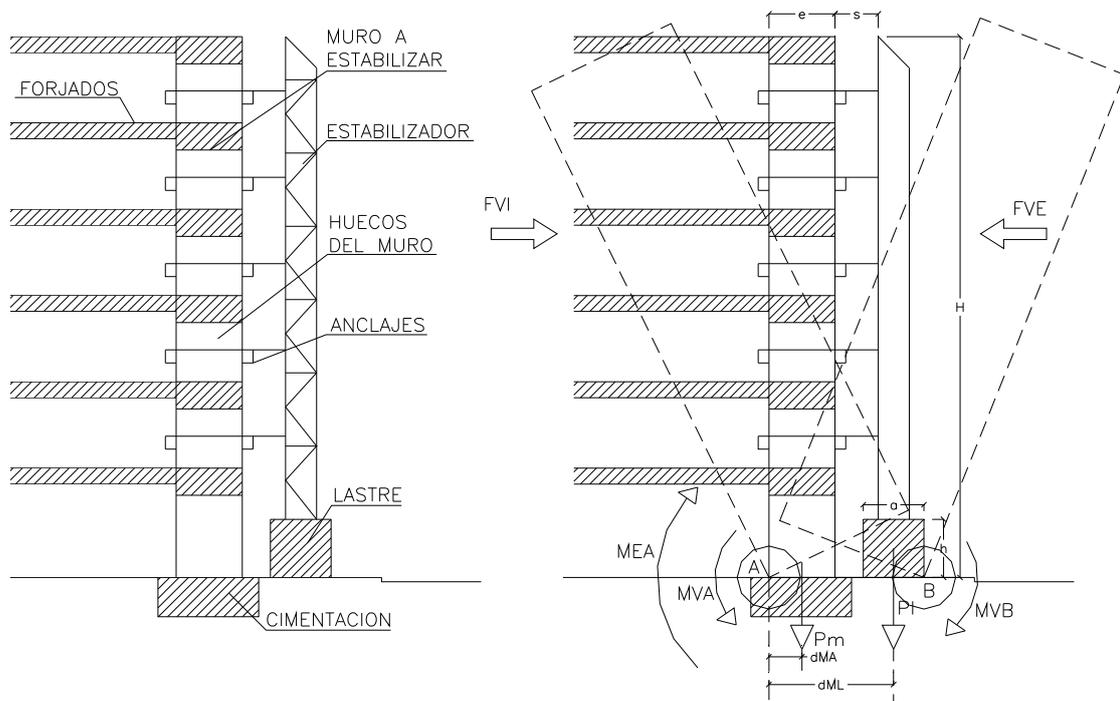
Modelo para el cálculo del lastre de un estabilizador de fachada
